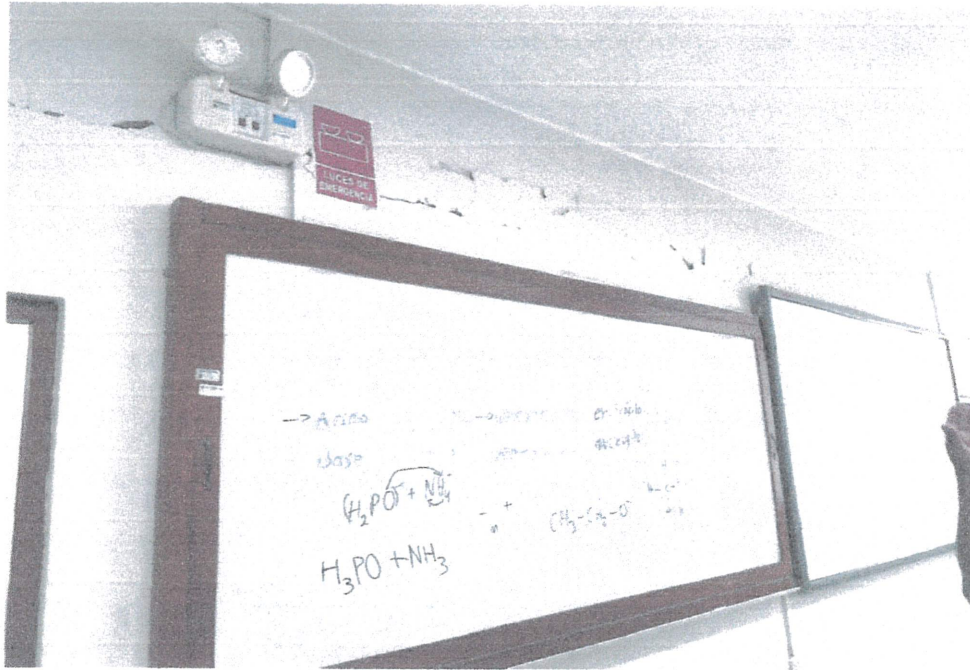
Presencia de fallas en la junta fría de los muros de albañilería con la viga principal.
